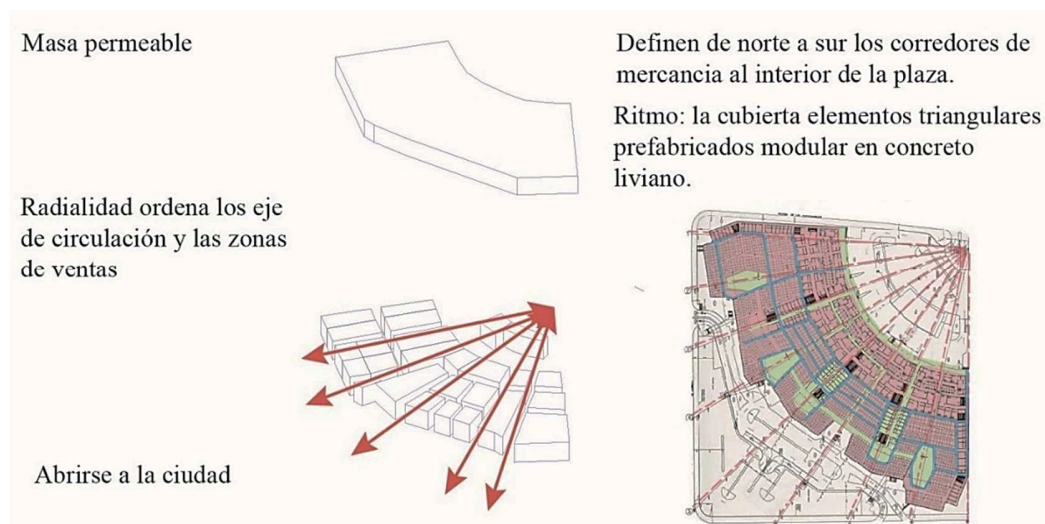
Esquema formal Plaza de mercado Paloquemao. Elaboración propia.
